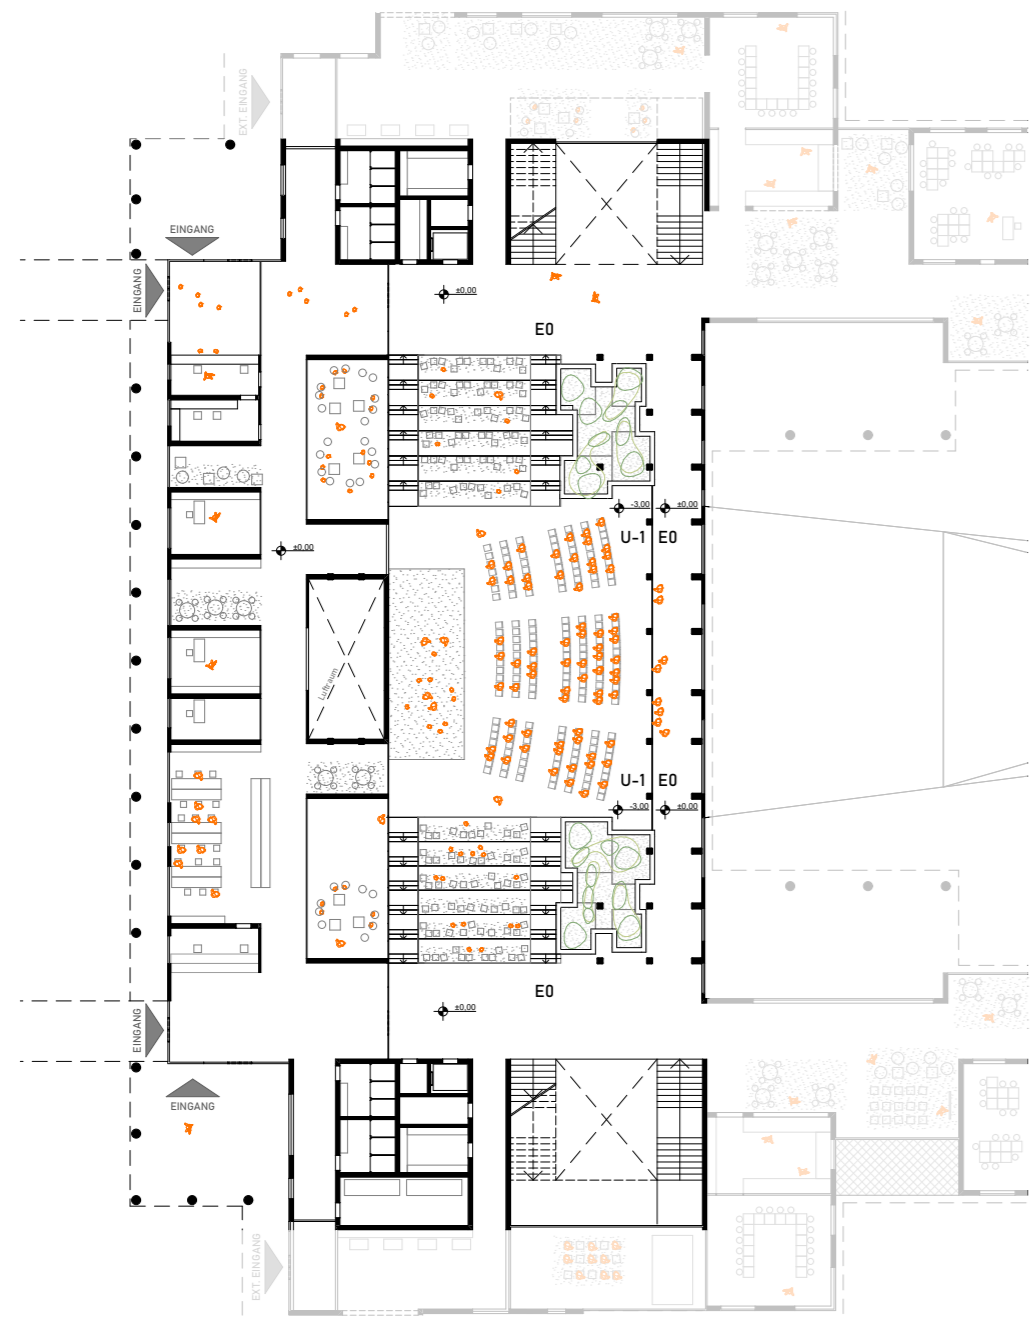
Grundriss Abschnitt-Veranstaltungsbereich
